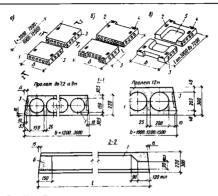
Плиты железобетонные сплошные для перекрытий жилых и общественных зданий:
